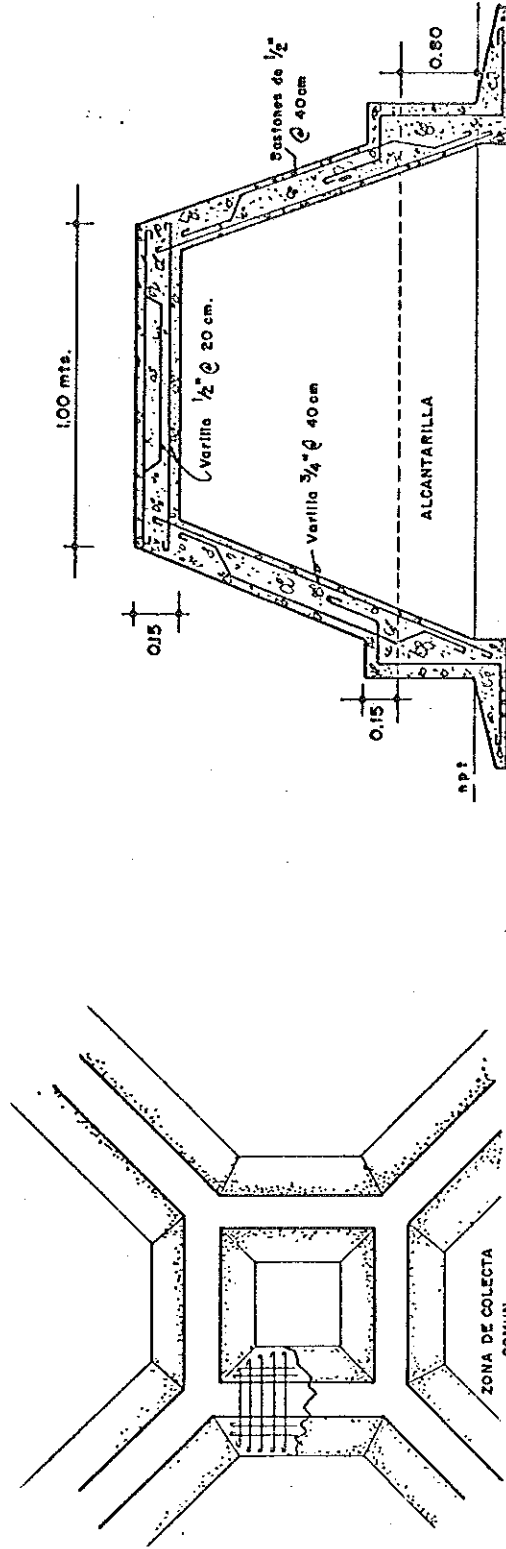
Detalle del armado de los muros en la zona de colecta .
